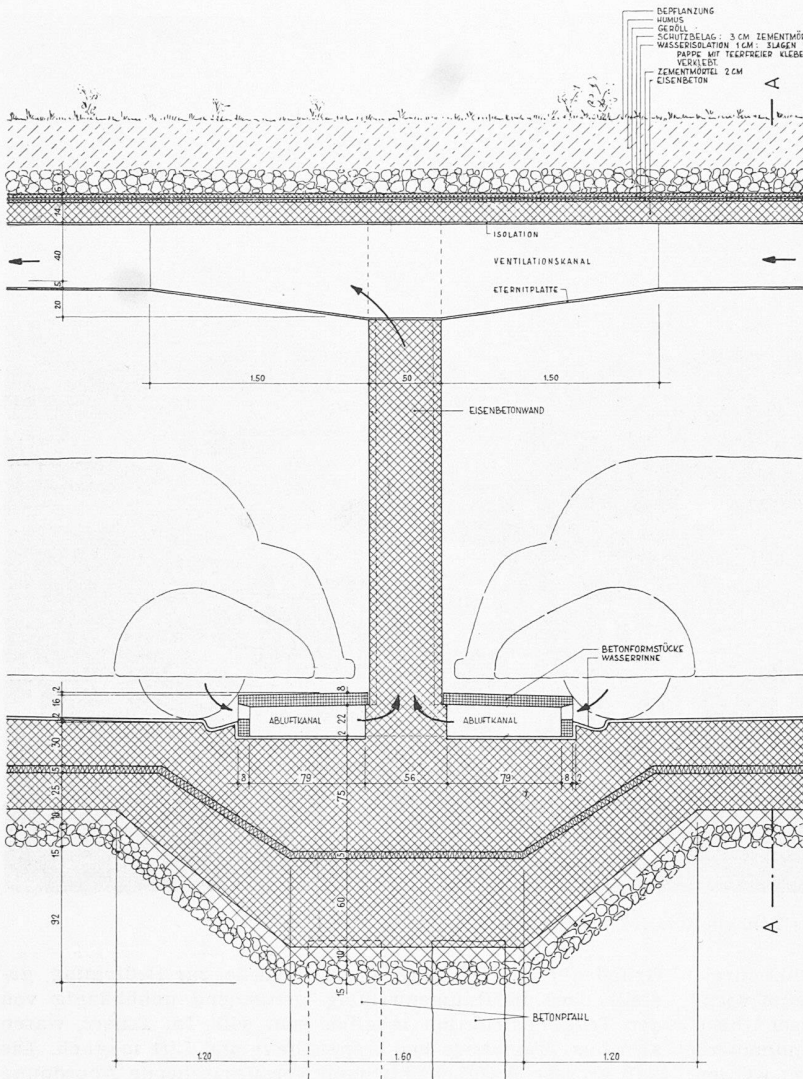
Querschnitt durch Boden, Tragwand und Decke der Garage, Masstab 1 : 50
